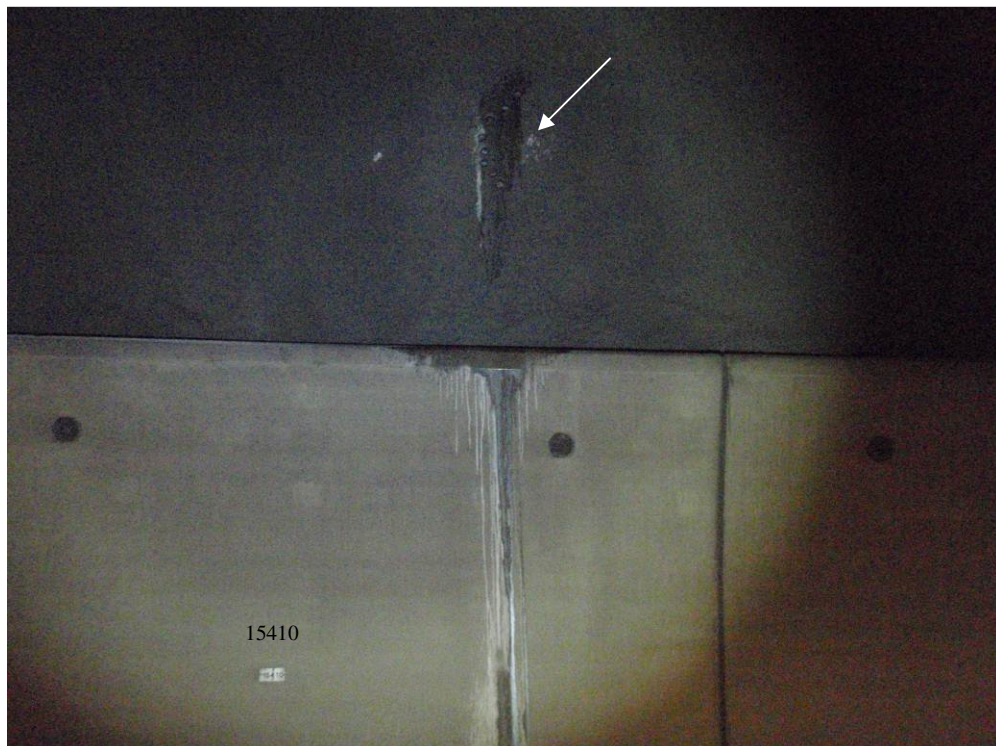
Km 15410 i hovedtunnelen under strandsonen på Hurumsiden. Typisk område med få lekkasjer gjennom betong. Lekkasje i kontakten mellom tunnelelementer og sprøytebetong.
